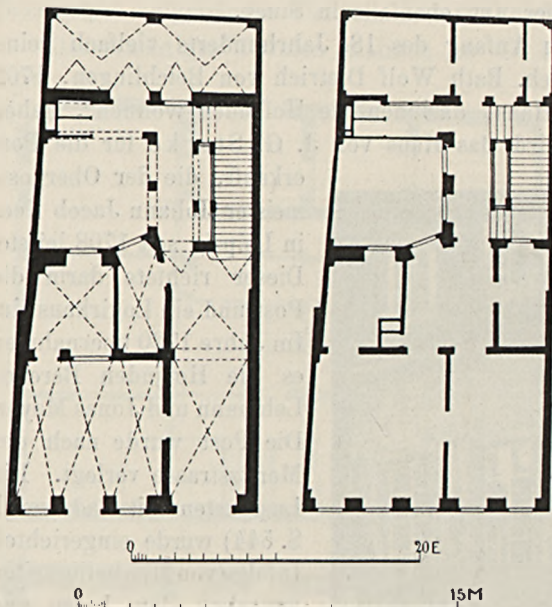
u. 536. Altmarkt Nr. 9. Grundriss des Erd- u. Obergeschosses.
